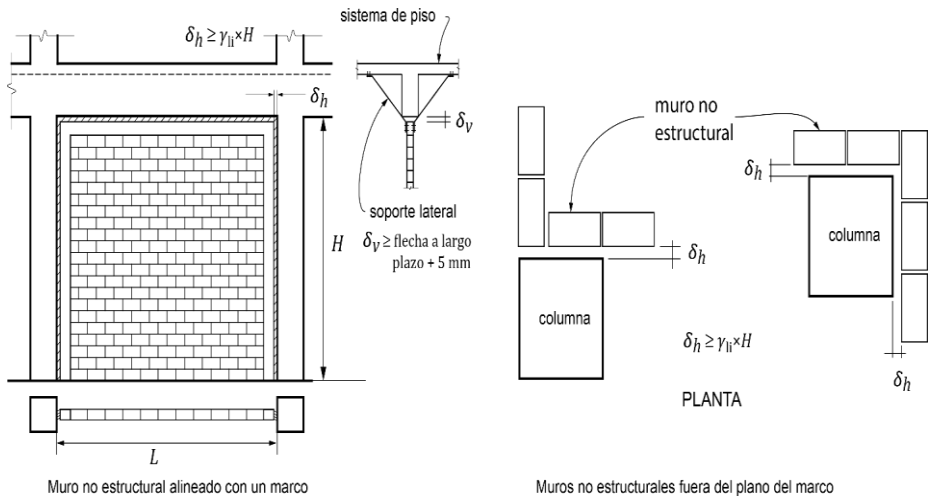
Holguras entre muros no estructurales y columnas y vigas
